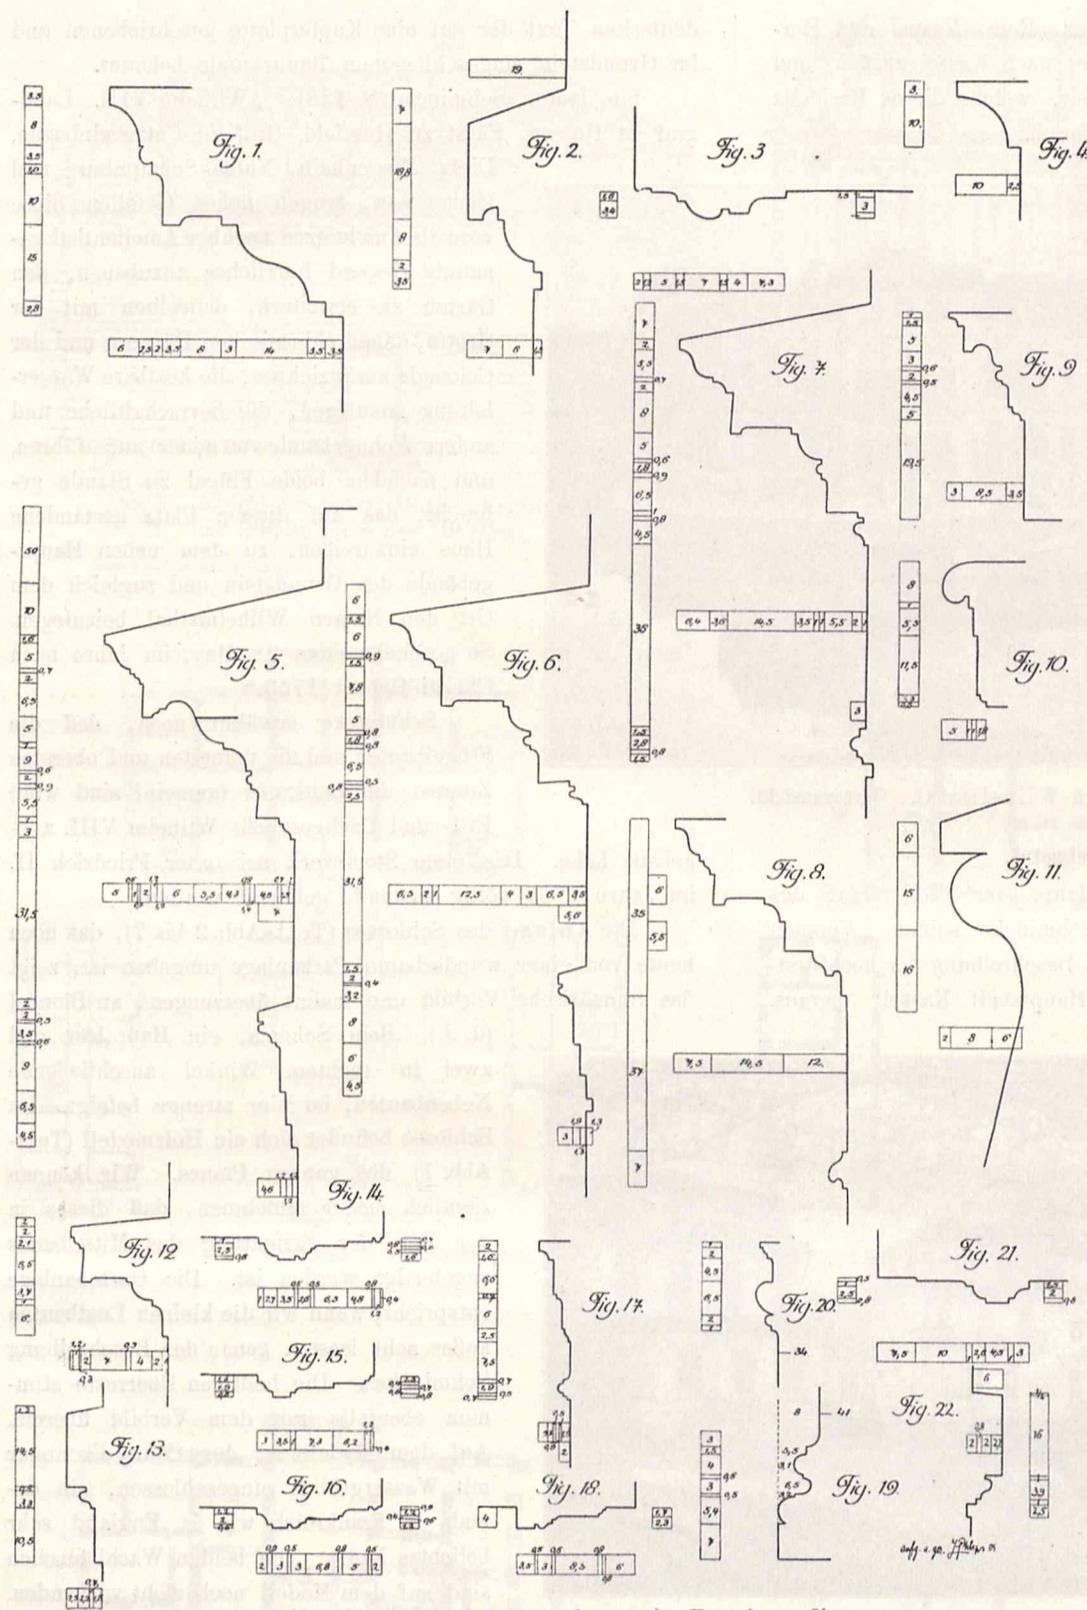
Schloß Wilhelmstal. Fassadenprofile.
